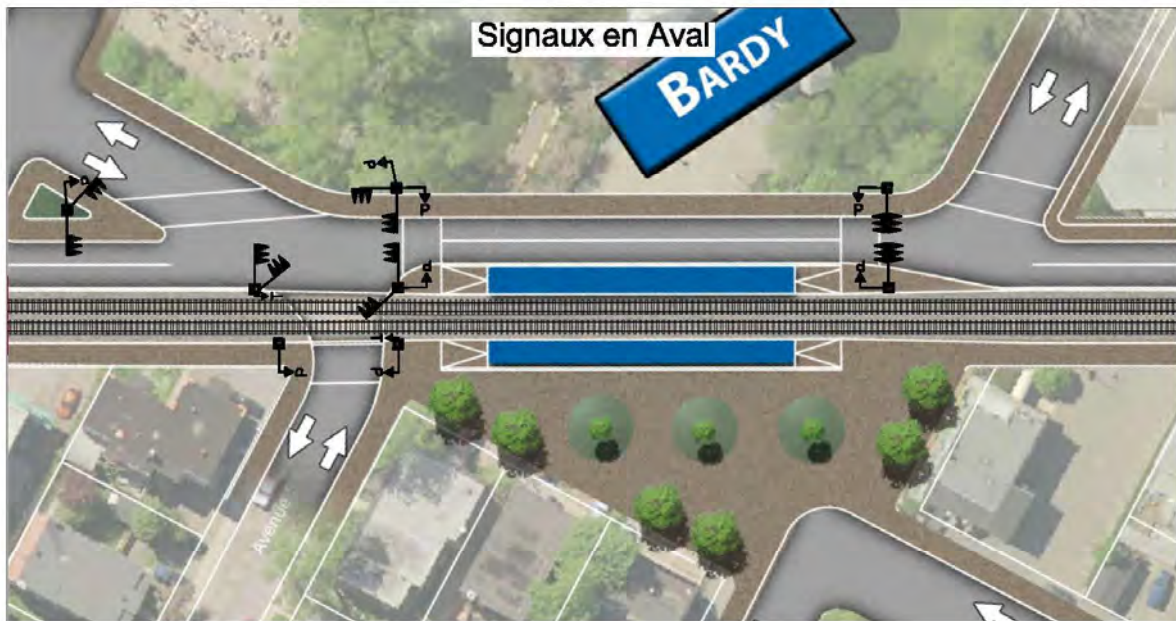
Disposition des signaux lumineux aux carrefours pour le tramway en site propre en position latérale – en station – sans mail central
